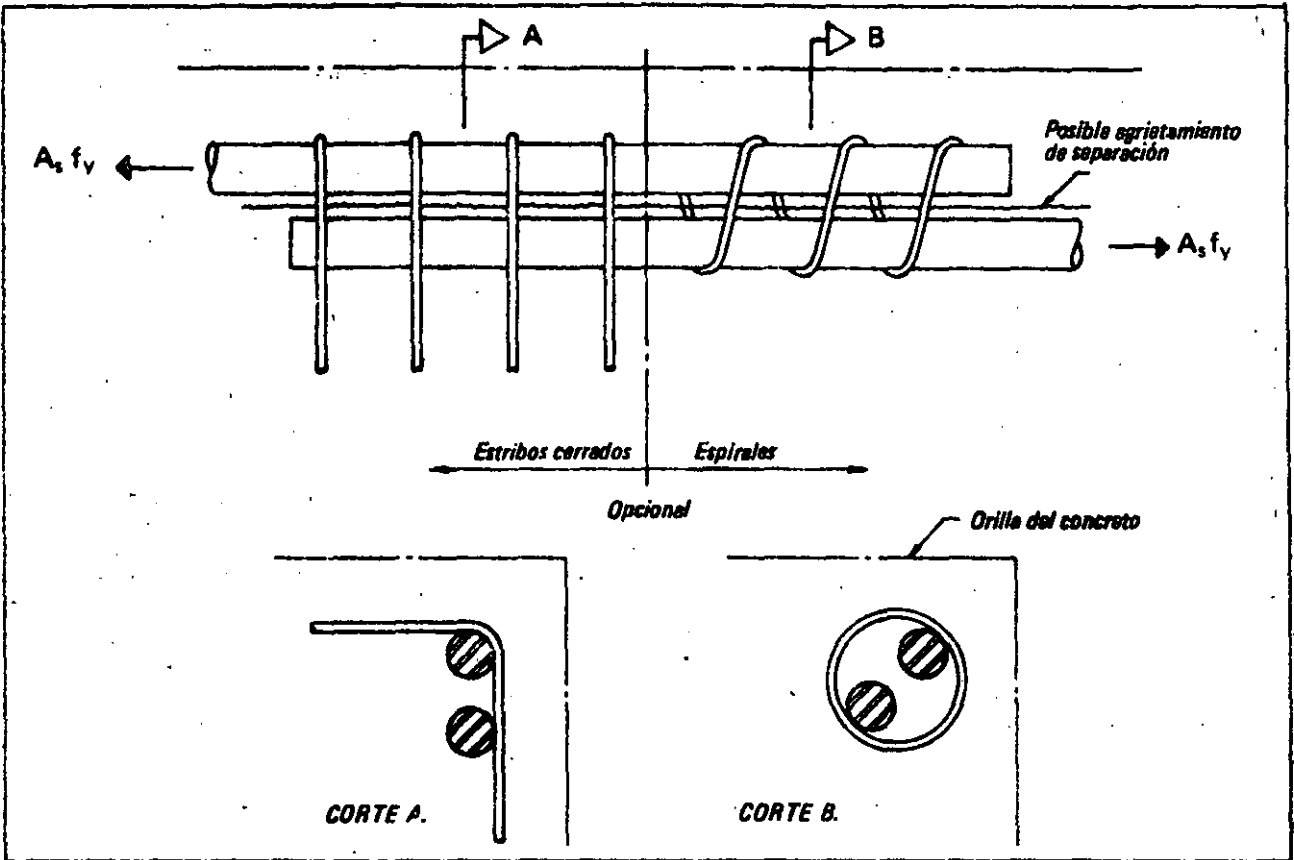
Refuerzo de confinamiento para uniones traslapadas
